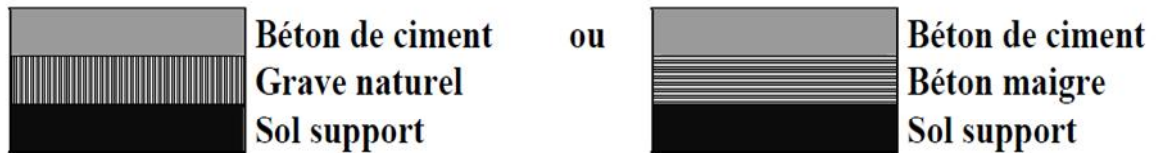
Illustration d'une structure de chaussée Rigide.
